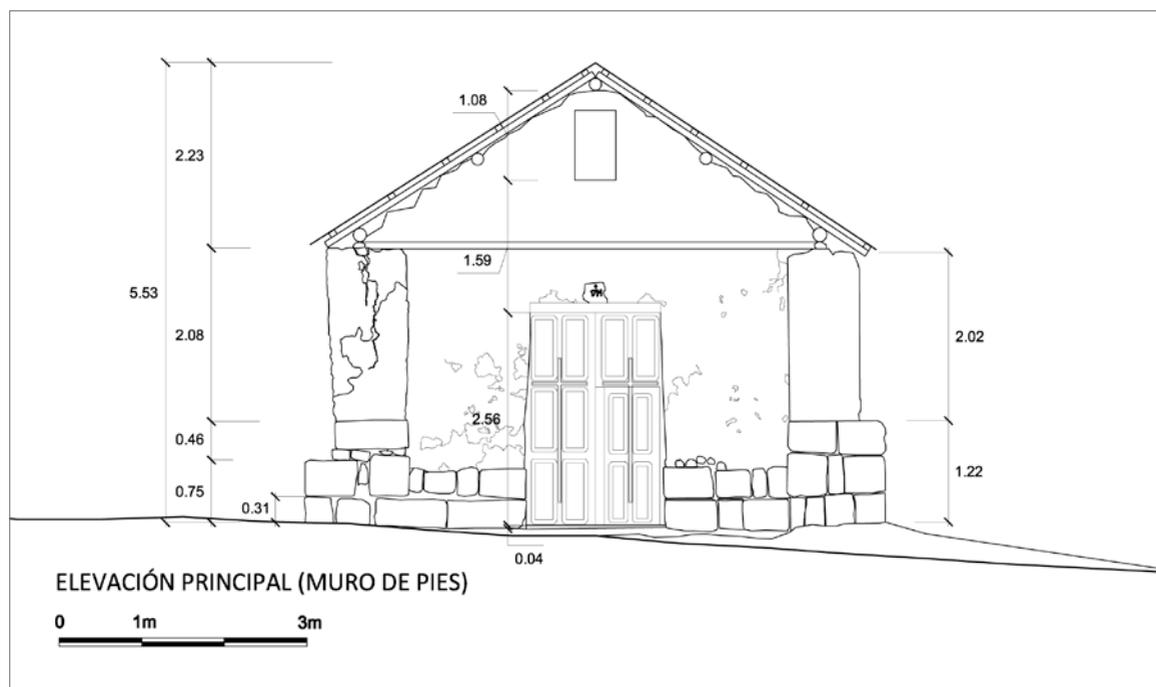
Levantamiento arquitectónico de la fachada (Fotografía y plano: Castro, T. 2014).
